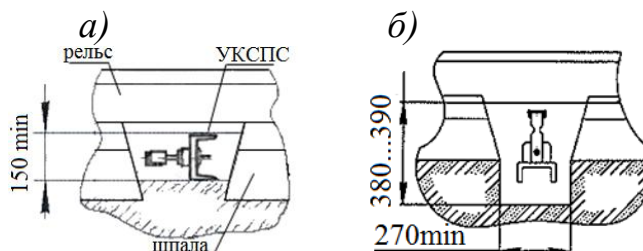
Углубление в насыпи для демонтажа и установки УКСПС на балке (а), на балке с дополнительной деревянной шпалой (б)
